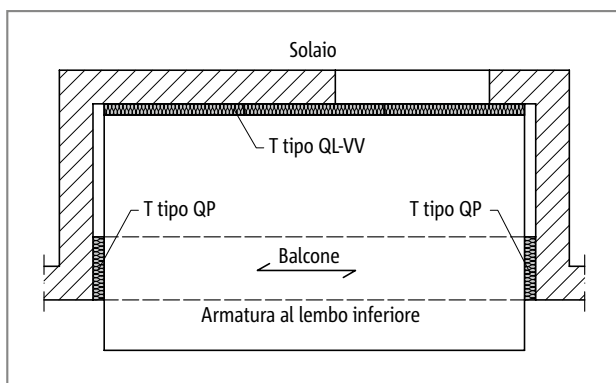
Schöck Isokorb® T QL-VV e QP: loggia appoggiata su tre lati
